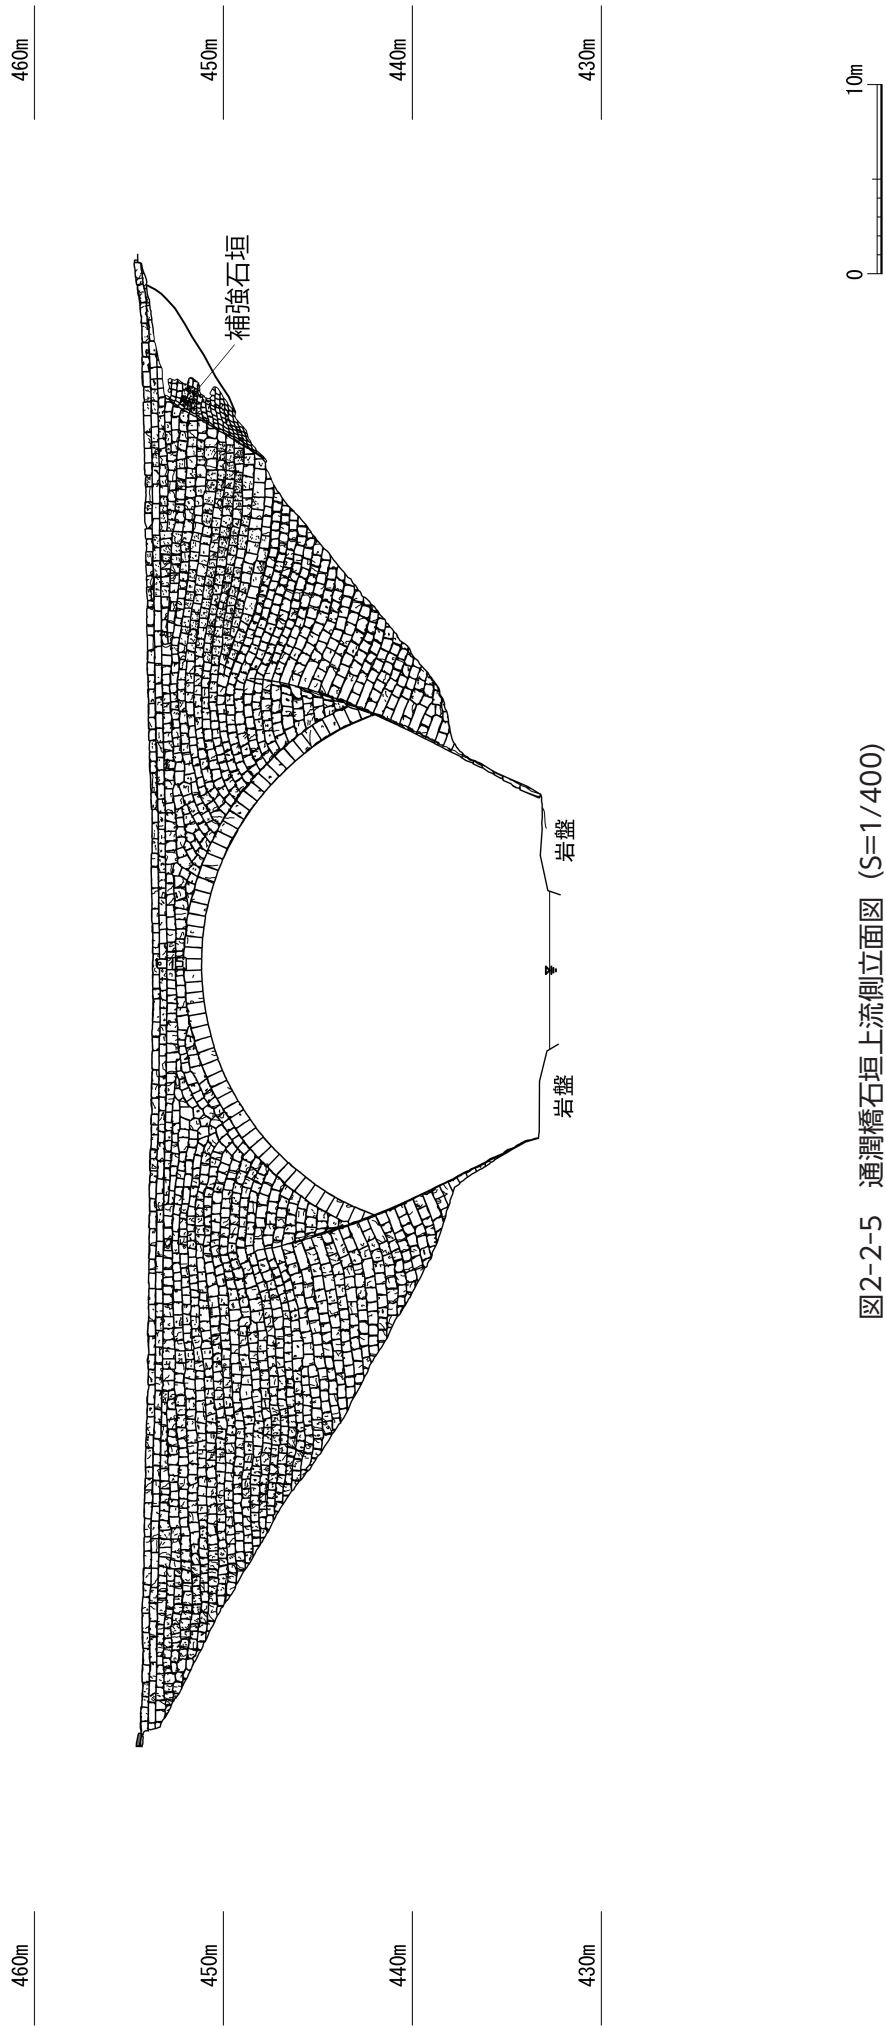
通潤橋石垣上流側立面图 (S=1/400)
